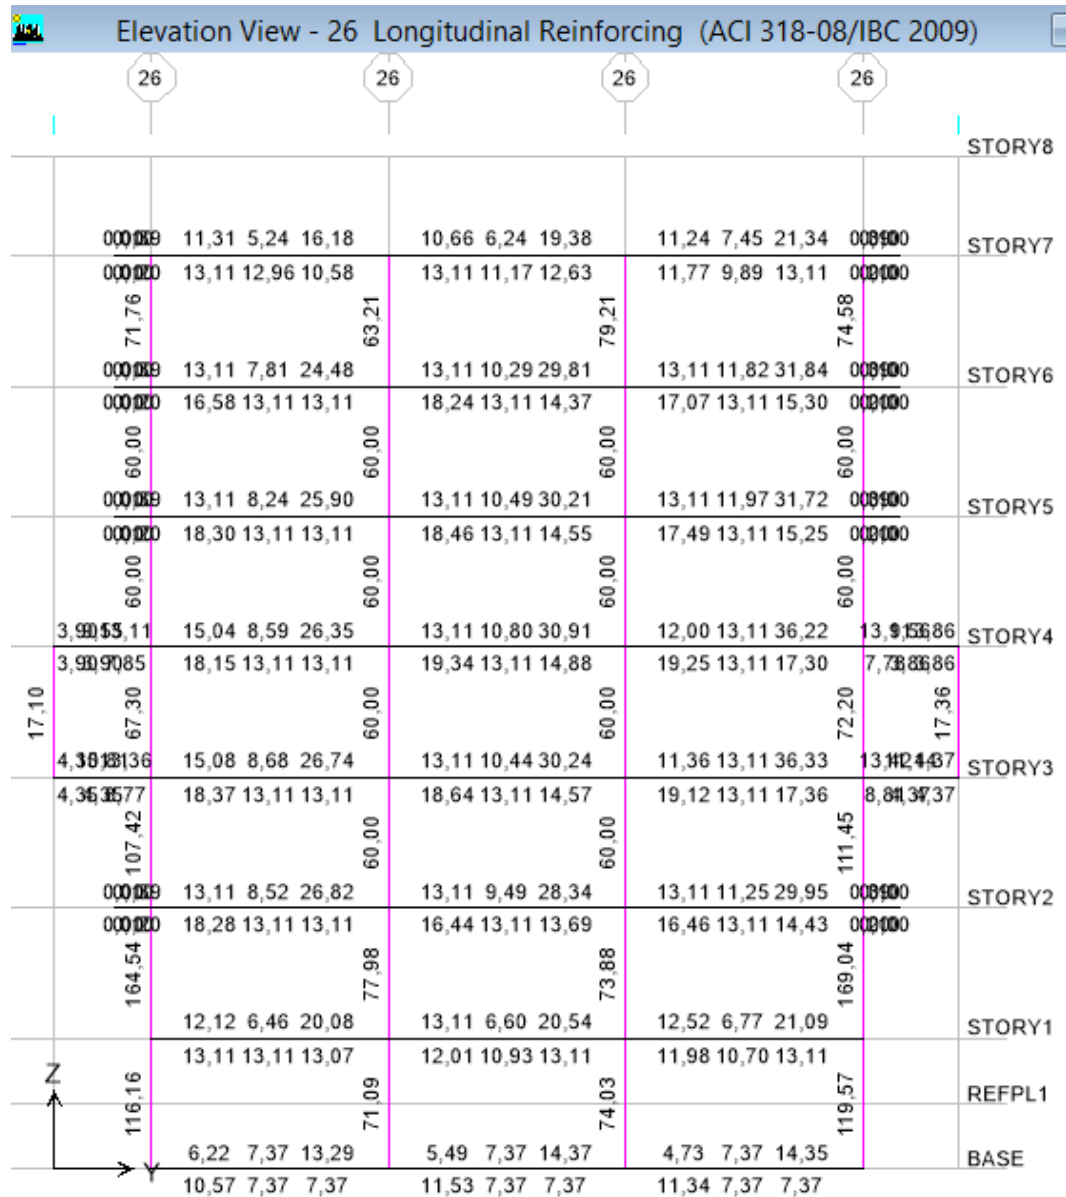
Acero en Vigas y Columnas en el Pórtico 26 – Hospitalización 2- (LRB+HDR)
